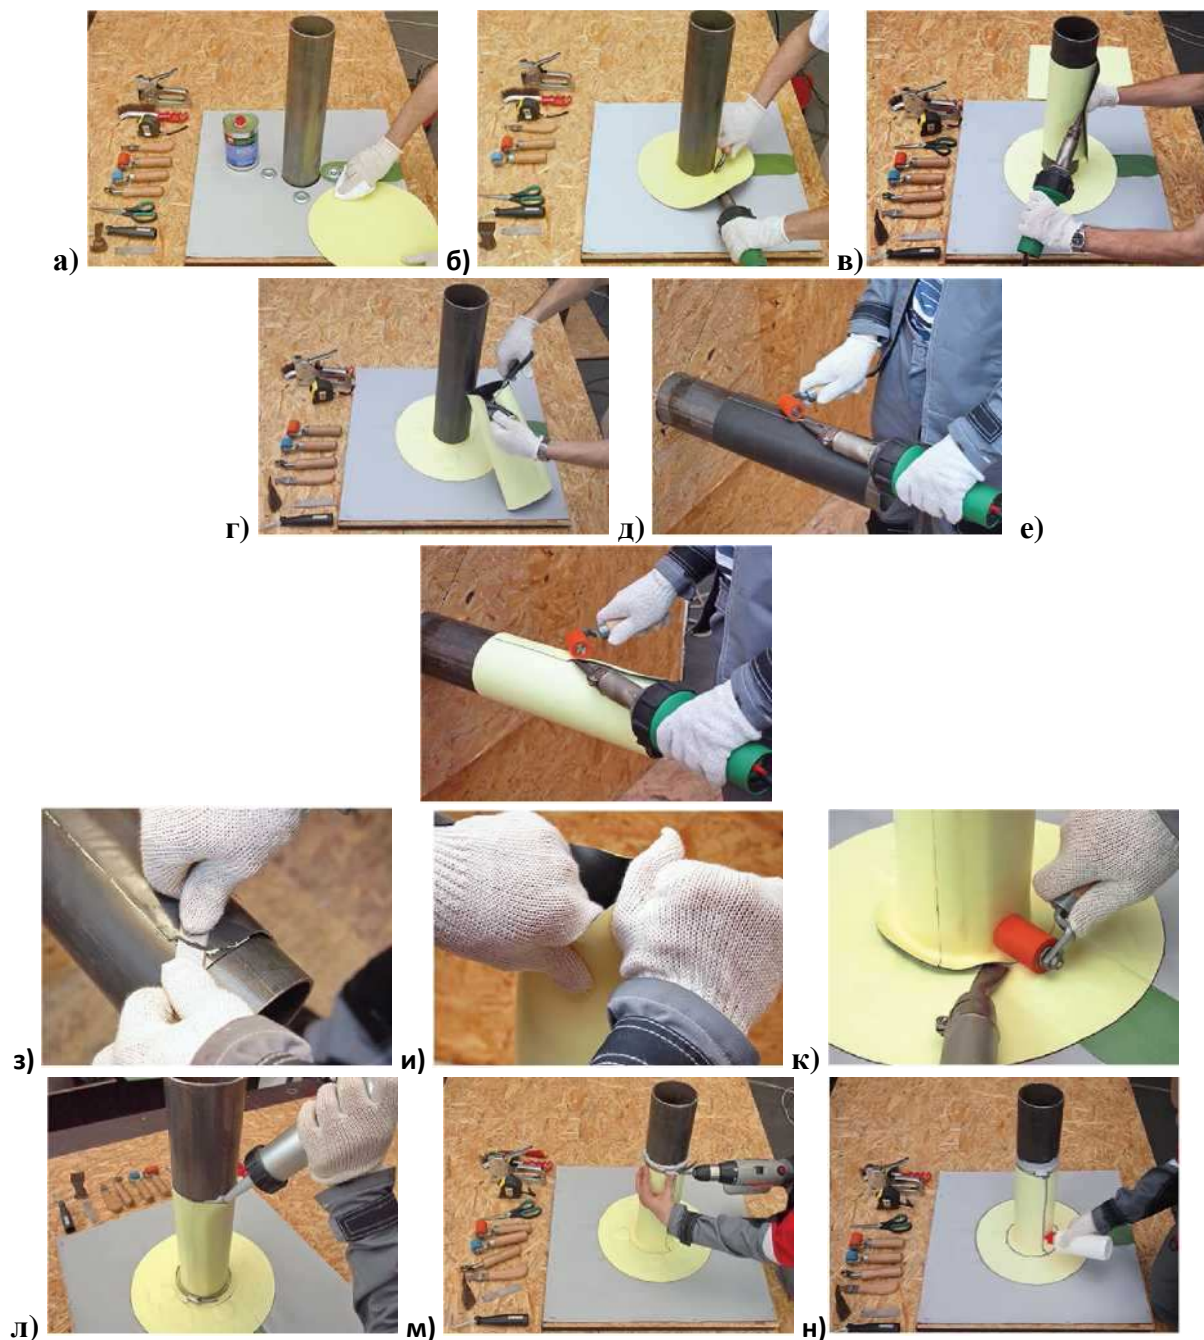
Монтаж примыкания полимерной неармированной мембраны к трубе
